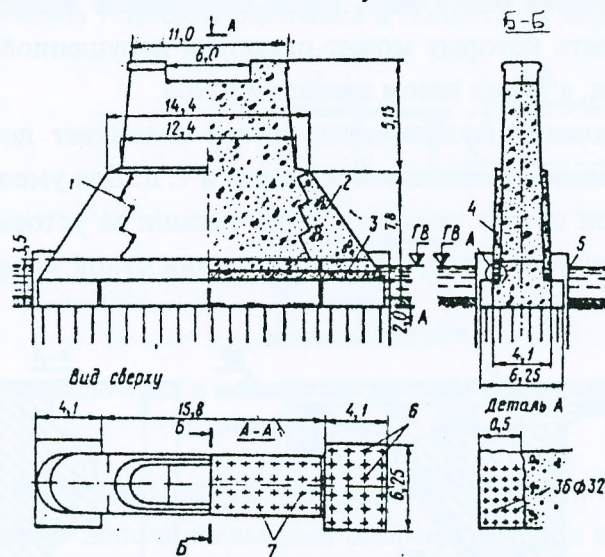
Усиление фундаментов: 1 – инъекционные трубки; 2 – бетонный контрфорс; 3 – железобетонный пояс; 4 – оболочка; 5 – шпунтовое ограждения; 6 – новые сваи диаметром 60 см; 7 – существующие сваи 30X30 см.
